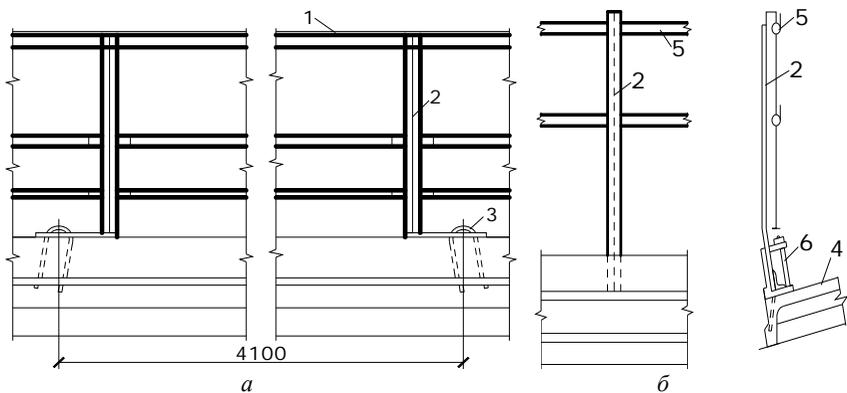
Временное ограждение по плитам покрытия (перекрытия):
